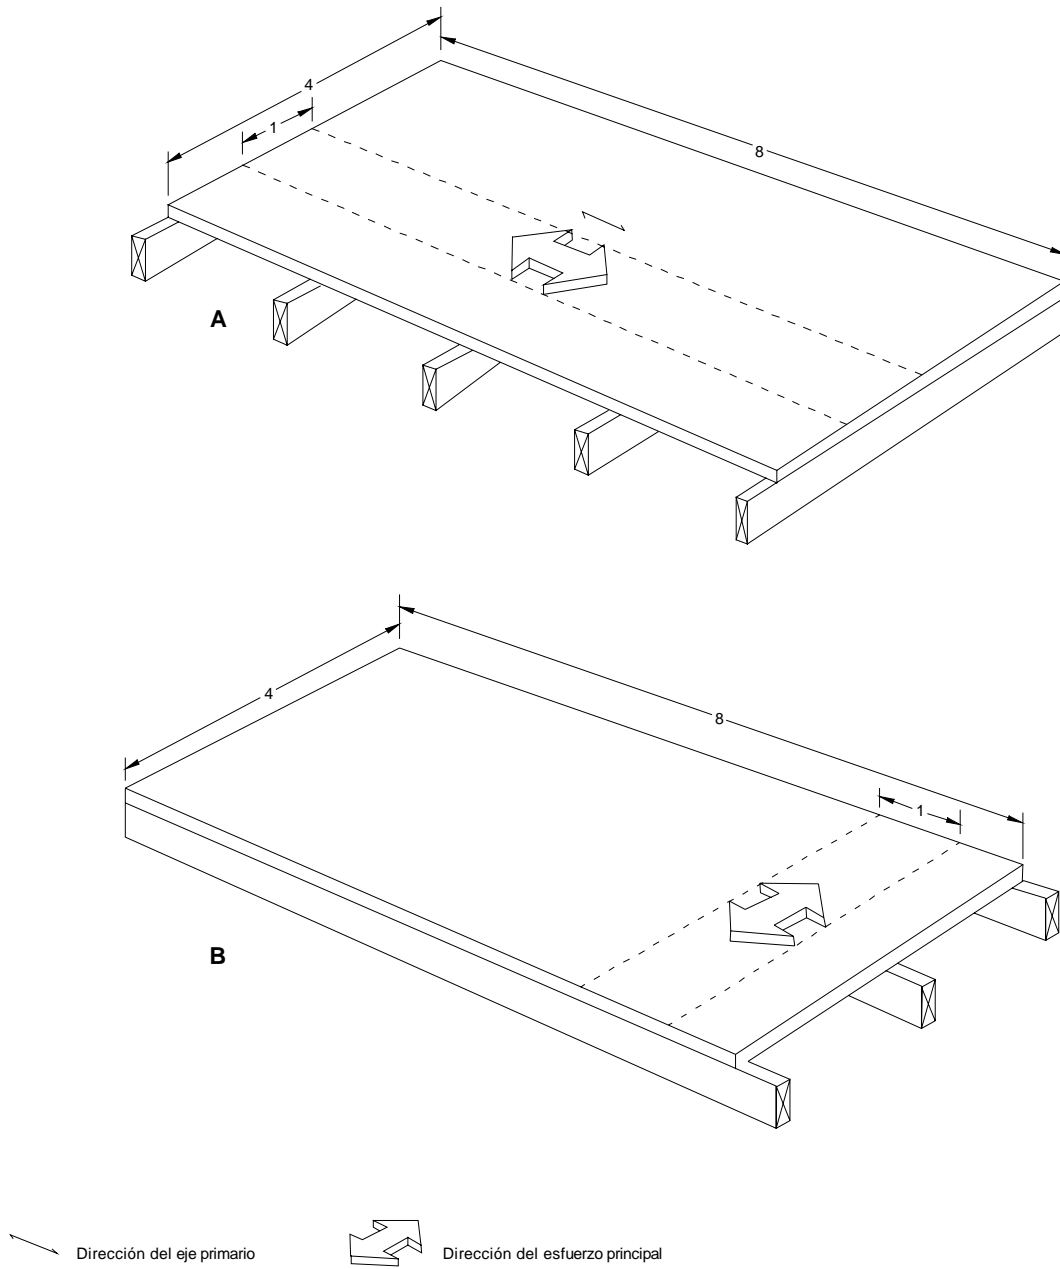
Paneles con la fuerza aplicada a lo largo de los ejes primario (A) y secundario (B).
